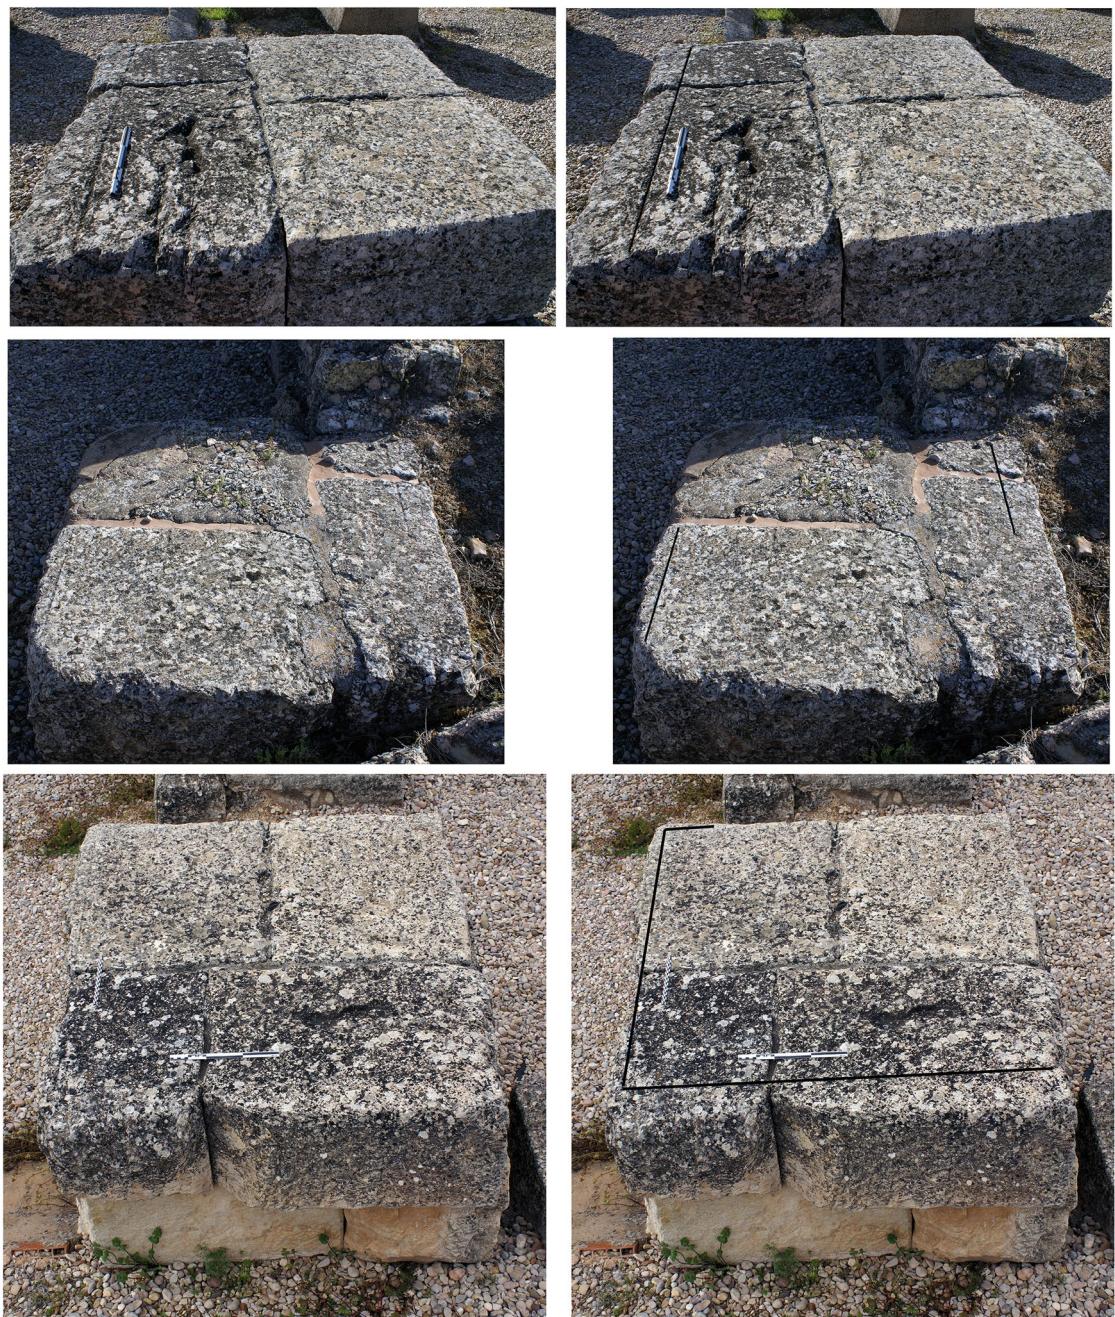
Trazos de replanteo sobre elementos arquitectónicos estructurales.
